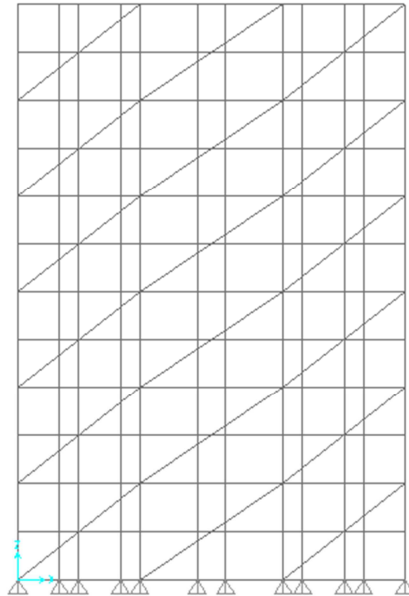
Configuração dos Planos de Contraventamento Vertical Com Elementos de Contraventamento Grandes
